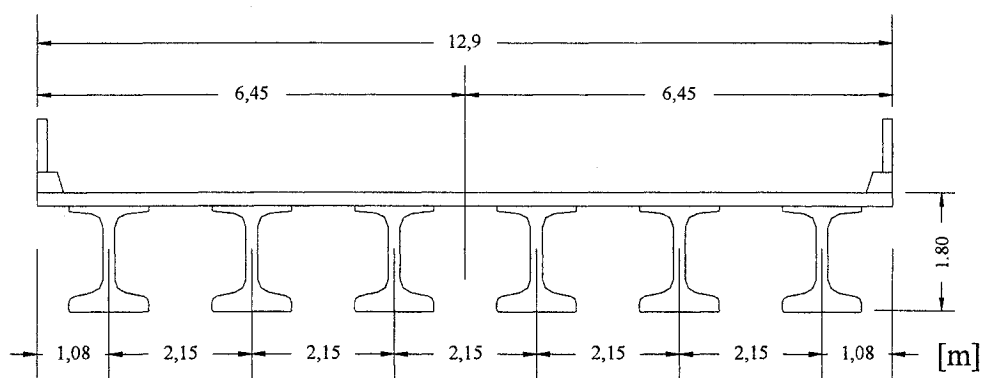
Dimensionnement original avec du BHP-50MPa : 6 poutres NEBT 1600
